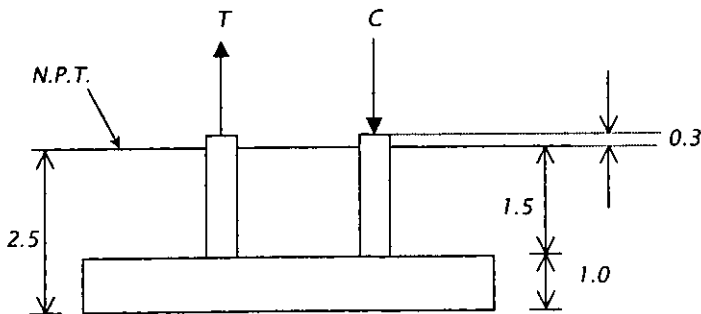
1. Esquema de Losa de Cimentación (Unidades en metros).
